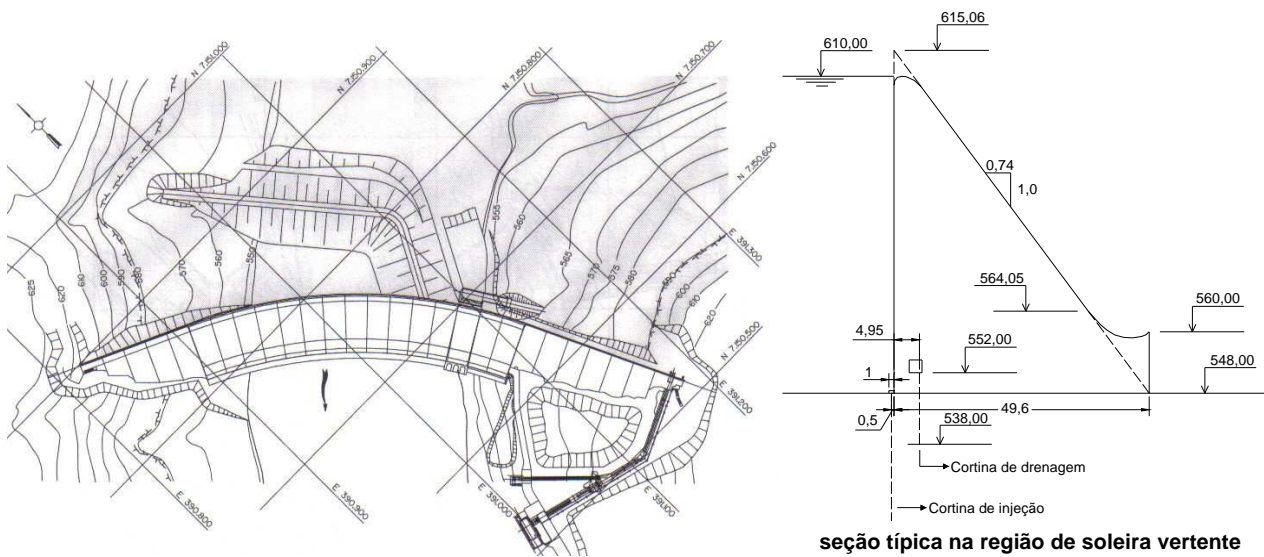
Planta e seção típica da barragem da derivação do rio Jordão
